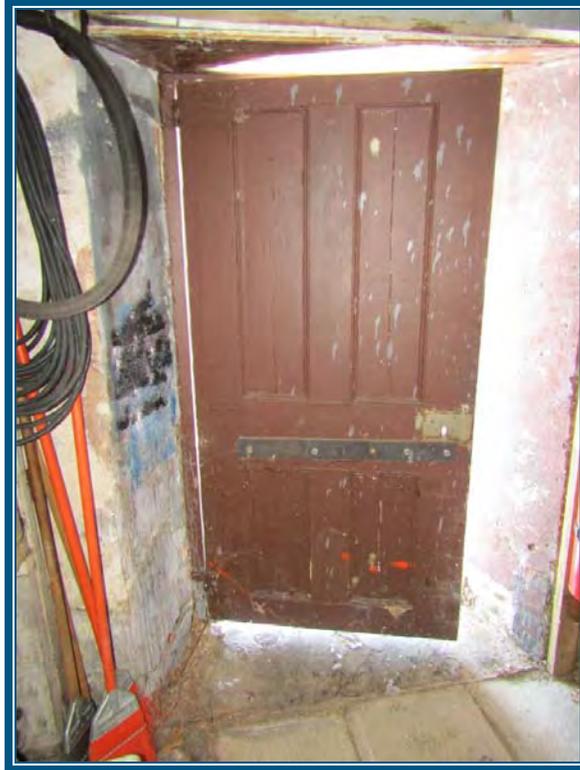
Porte d'entrée de l'entrepôt peinte en brun
